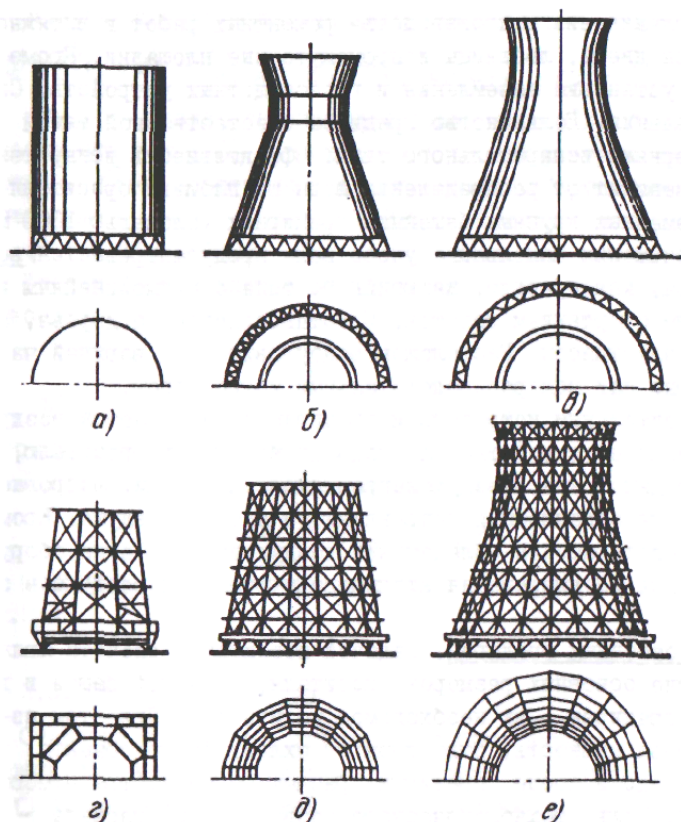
Вытяжные башни градирен железобетонные (а - цилиндрическая; б - биконическая; в - гиперболоидная) и каркасно-обшивные (г - пирамидальная восьмигранная с квадратным основанием; д - пирамидальная многогранная; е - гиперболоидная)
